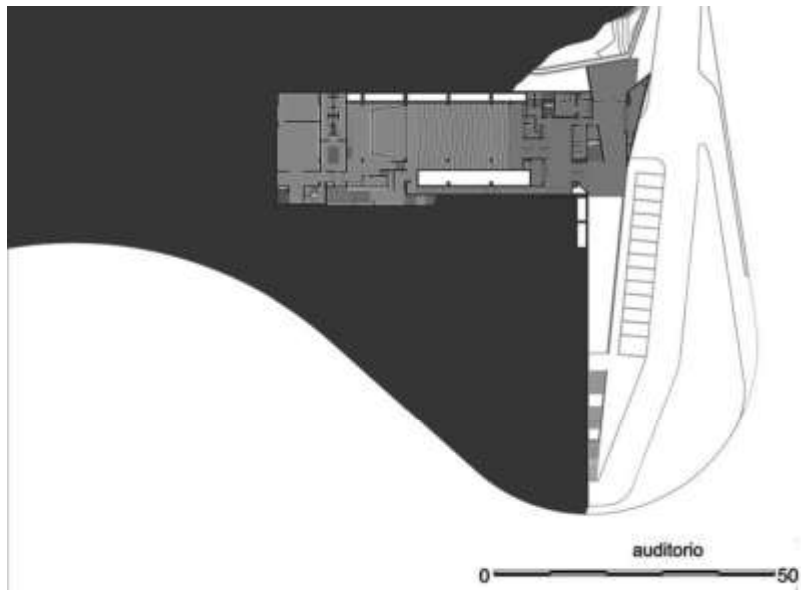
LUM. Planta auditorio. Nivel -4,50 m. Estudio Barclay & Crousse
